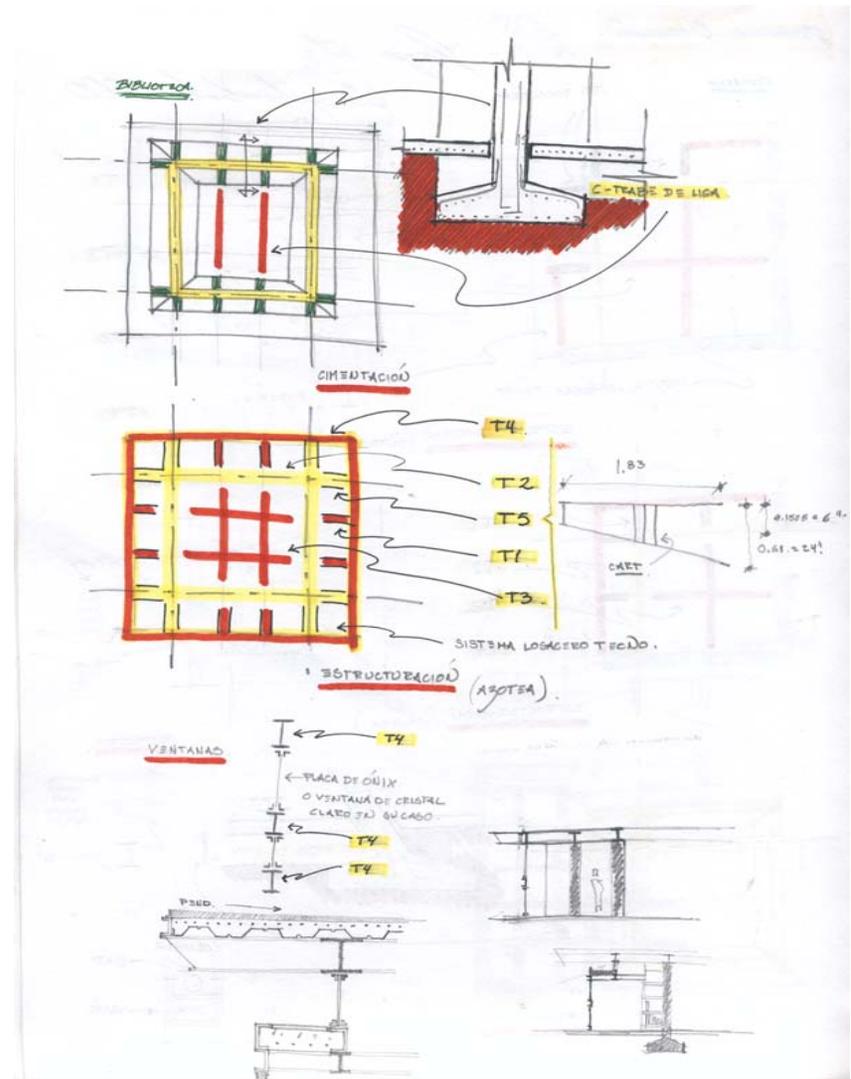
Estructura de losa de azotea, cimentación y corte por fachada. Biblioteca.
